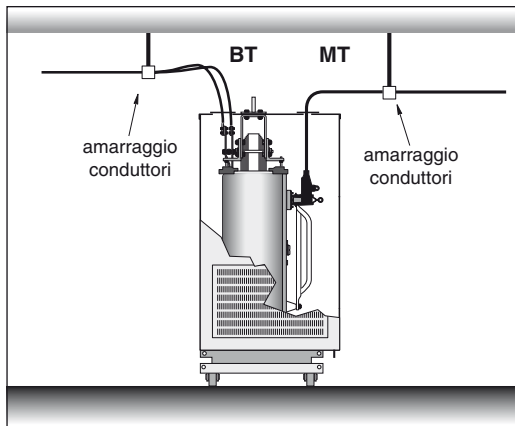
collegamenti MT e BT provenienti dall'alto.
